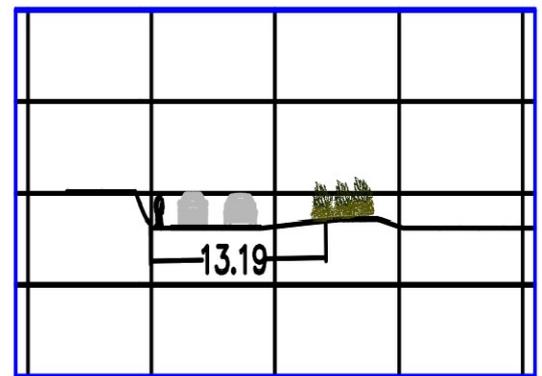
Plano de planimetría general (A-01), no identifica la presencia de un canal que atraviesa el ancho de sección de vía de la carretera.
